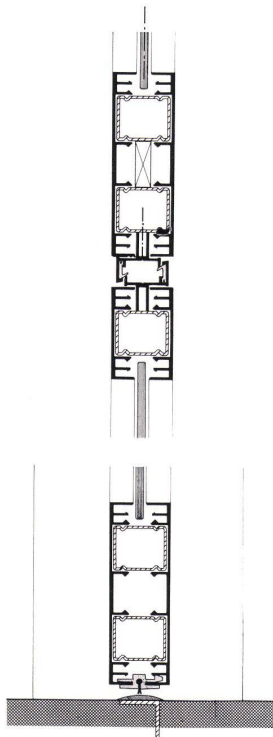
zeigt den Einbau einer Ganzglastüre mit Anschlag auf Gummidichtung.
